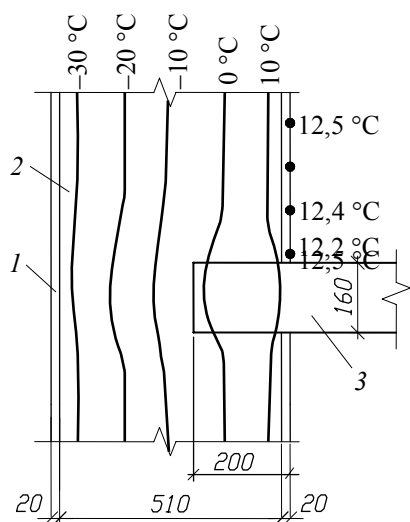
Распределение температур в месте опирания железобетонной плиты на кирпичную стену к примеру 3.8:
